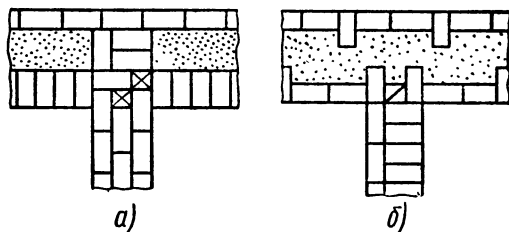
Порядковая раскладка кирпичей при кладке примыканий облегченных стен:
